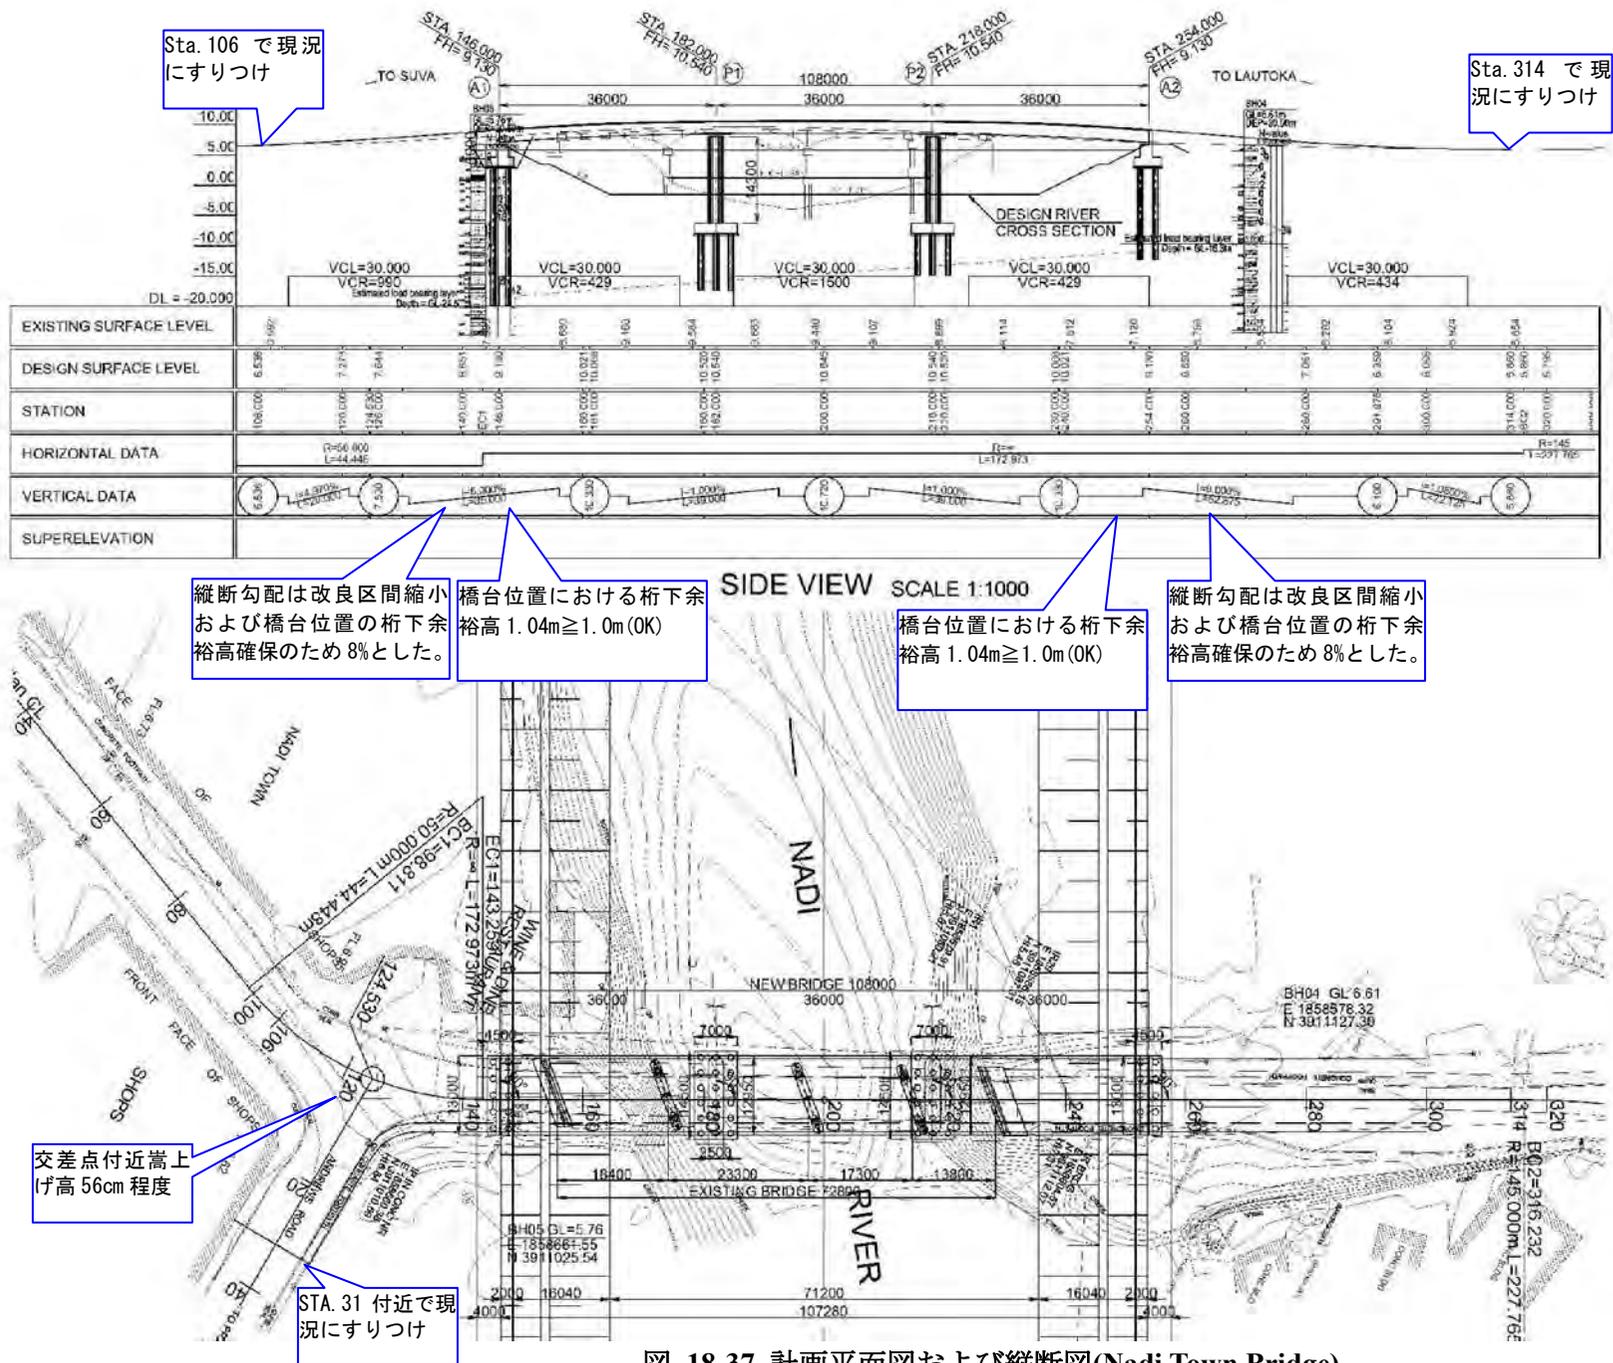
計画平面図および縦断図(Nadi Town Bridge)
